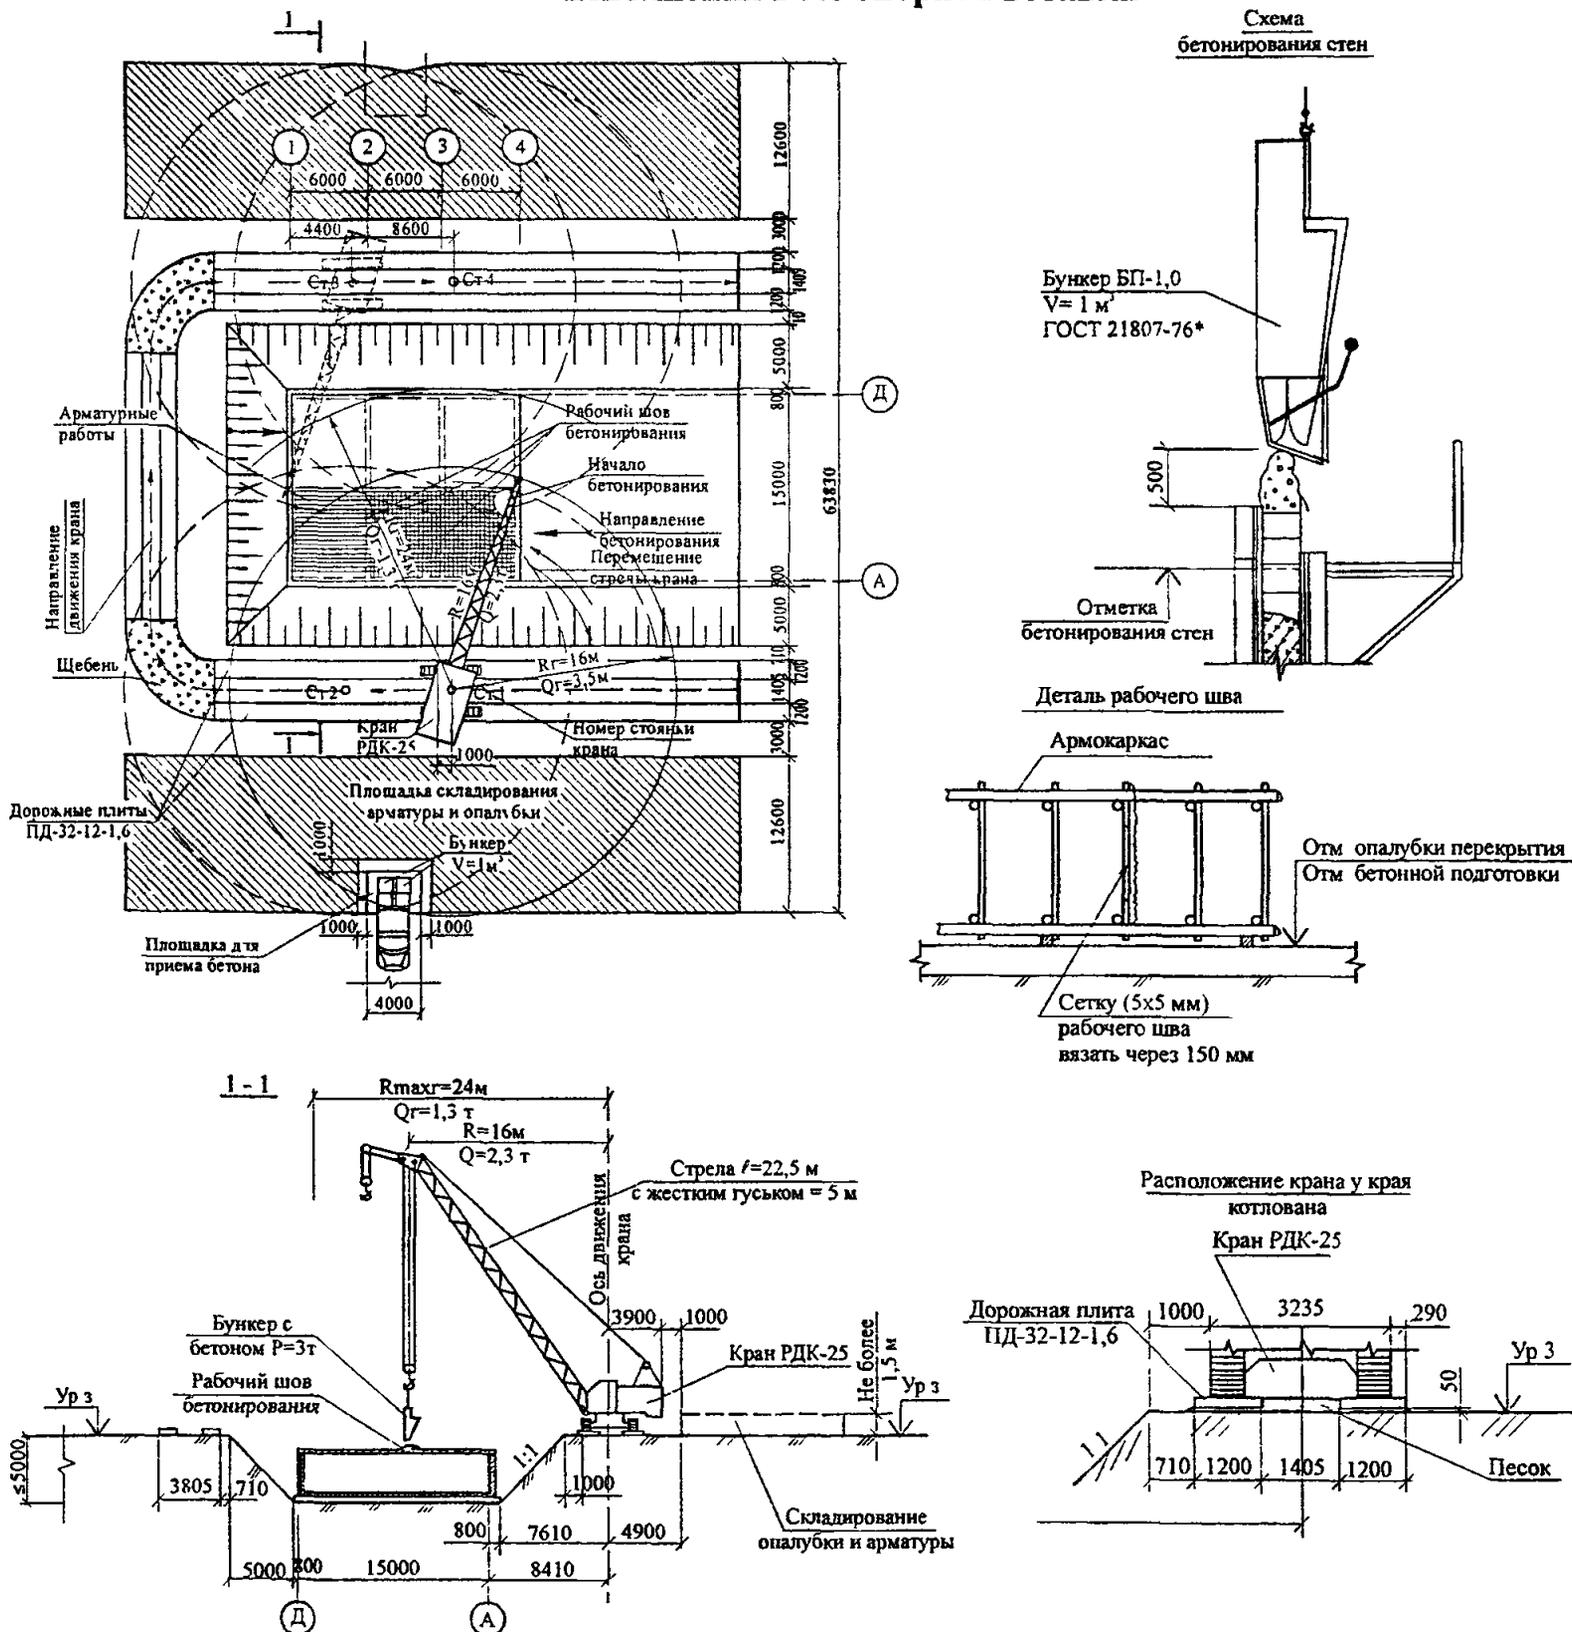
Производство работ при возведении конструкций ГО из монолитного железобетона краном РДК-25
